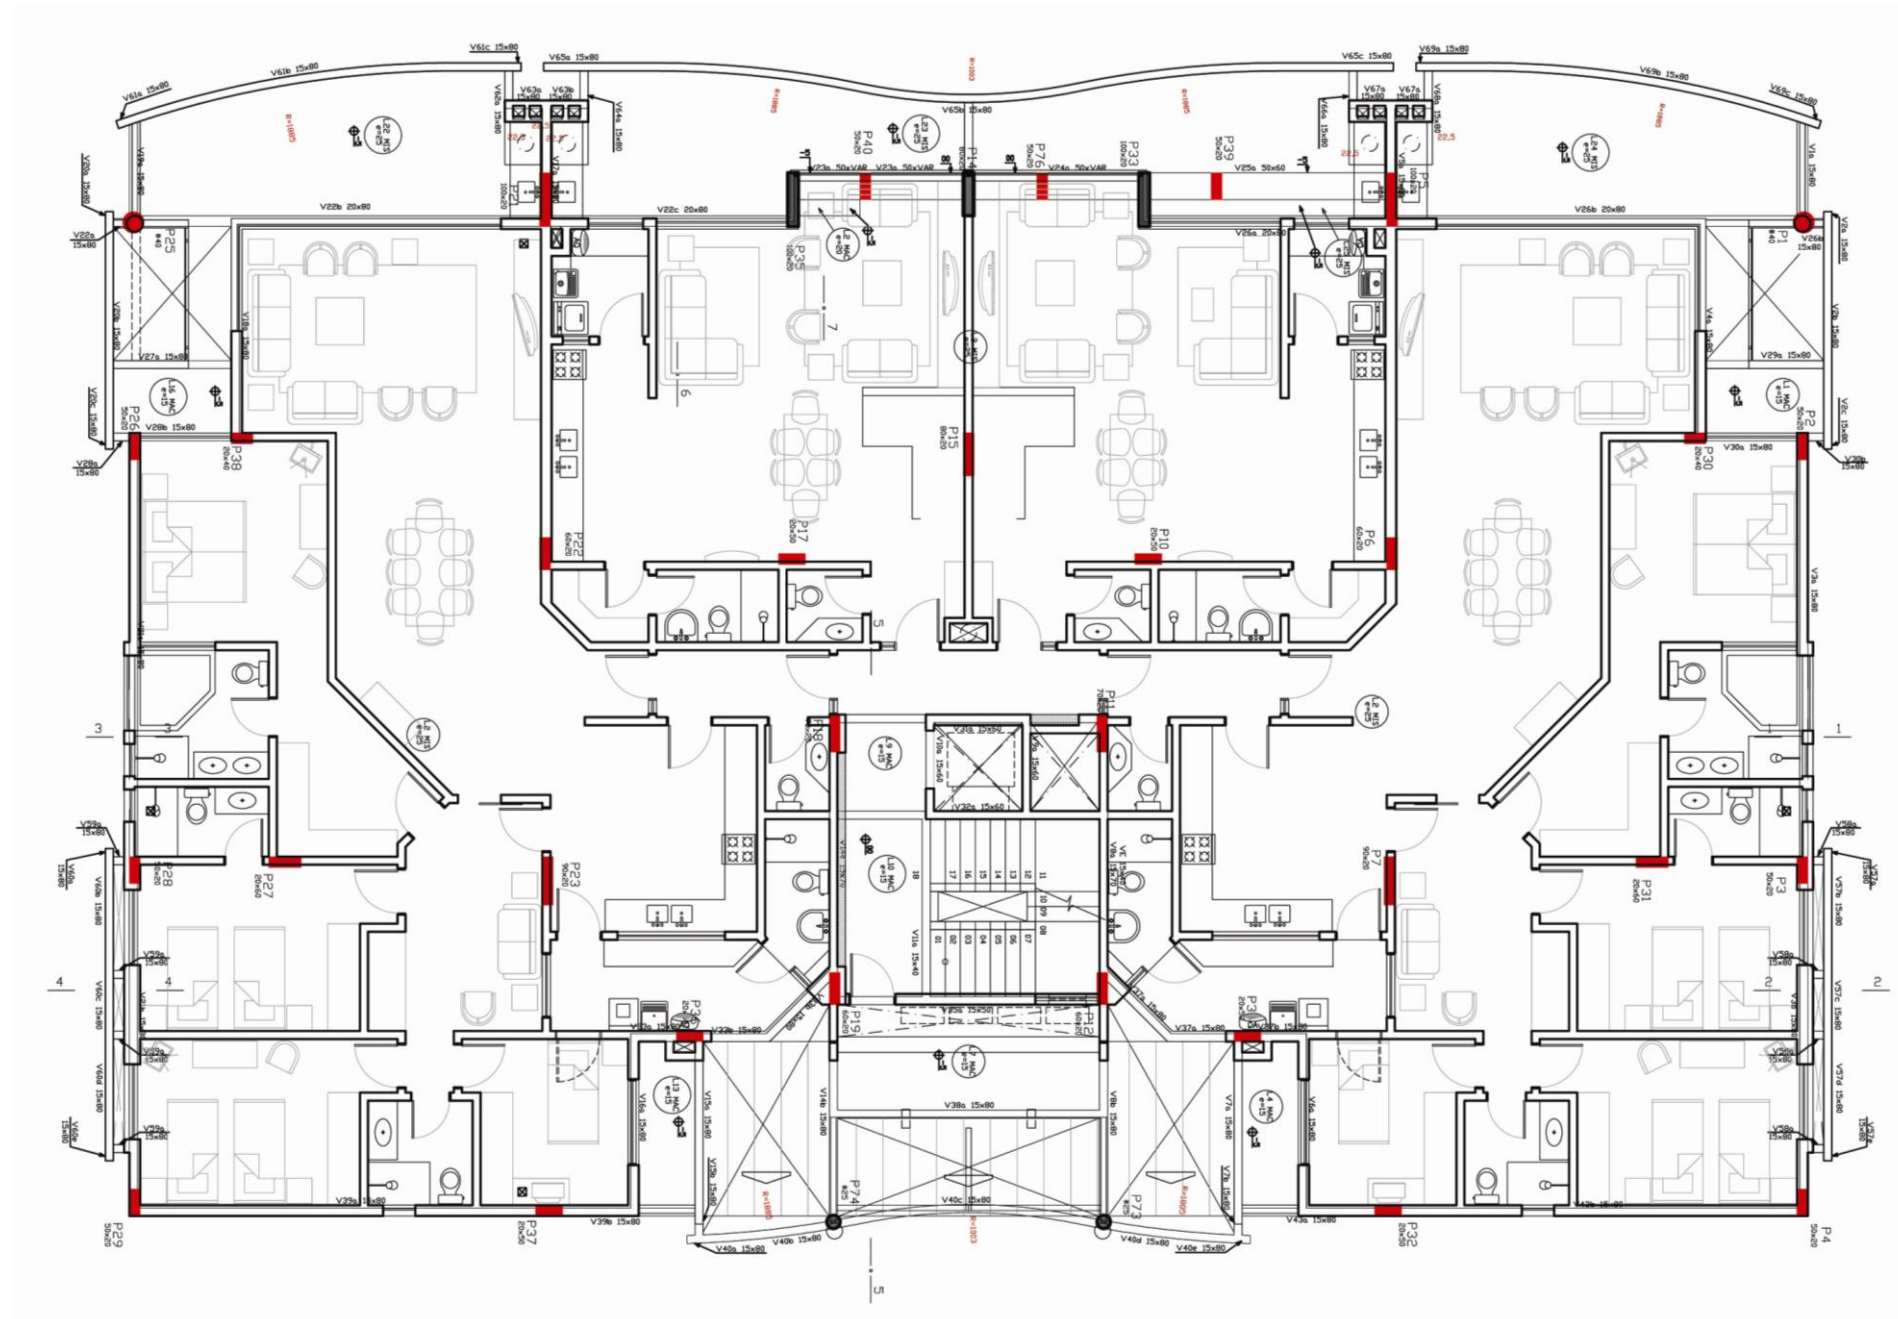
Planta baixa dos projetos arquitetônico e estrutural. .
